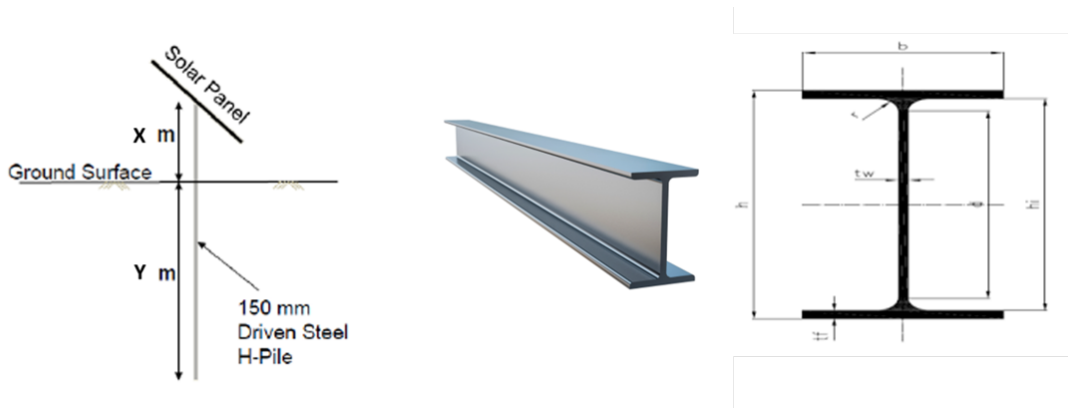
Detalle de perfil de acero típico para la cimentación de parques fotovoltaicos
